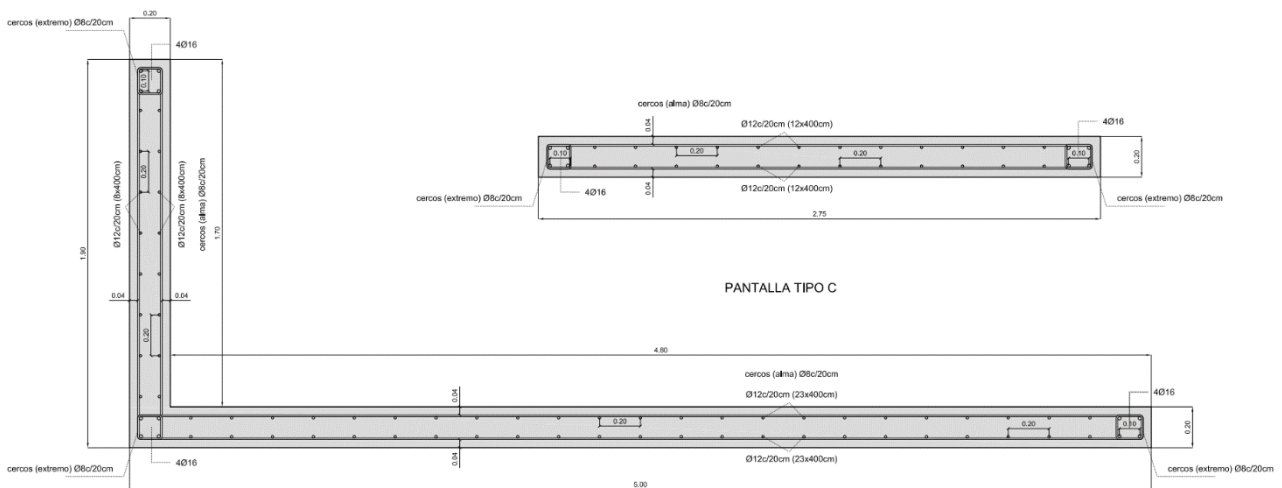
Sección de muros M.04-M.08 con armado. Fuente: David Gallardo.
